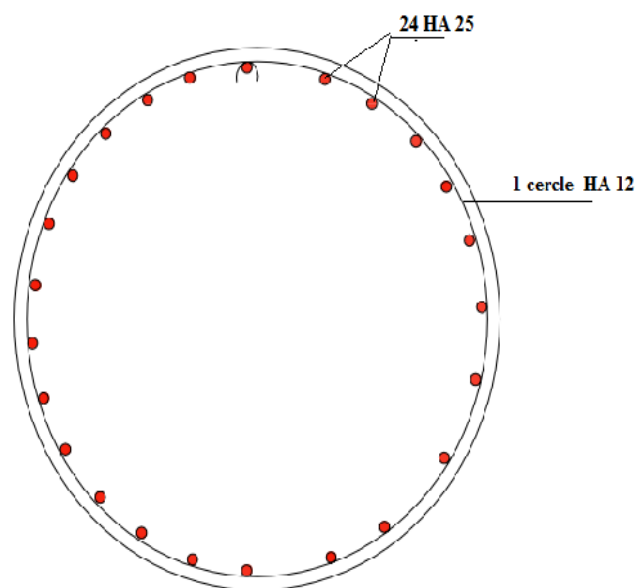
Ferrailage du pieu de la pile (coupe transversale).
